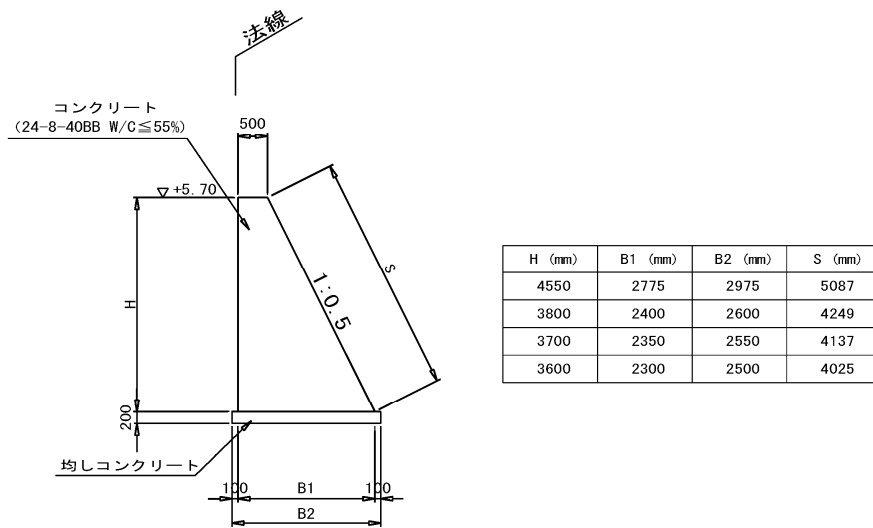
施工事例 副堤断面図（下新川海岸・生地）
